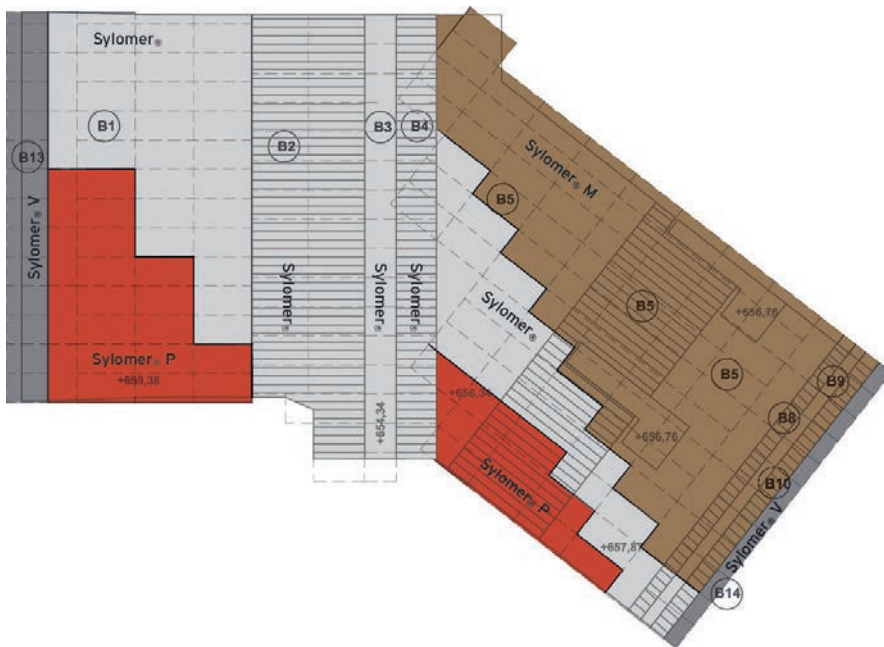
Verlegeplan, Kraftwerk Keselstraße
